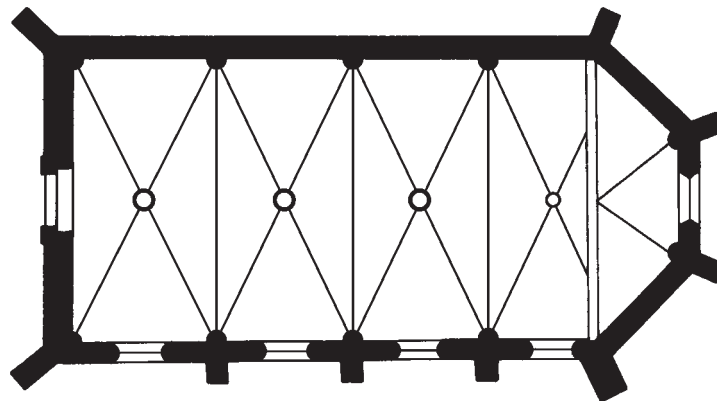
Grundriss der St. Johannes-Kapelle
